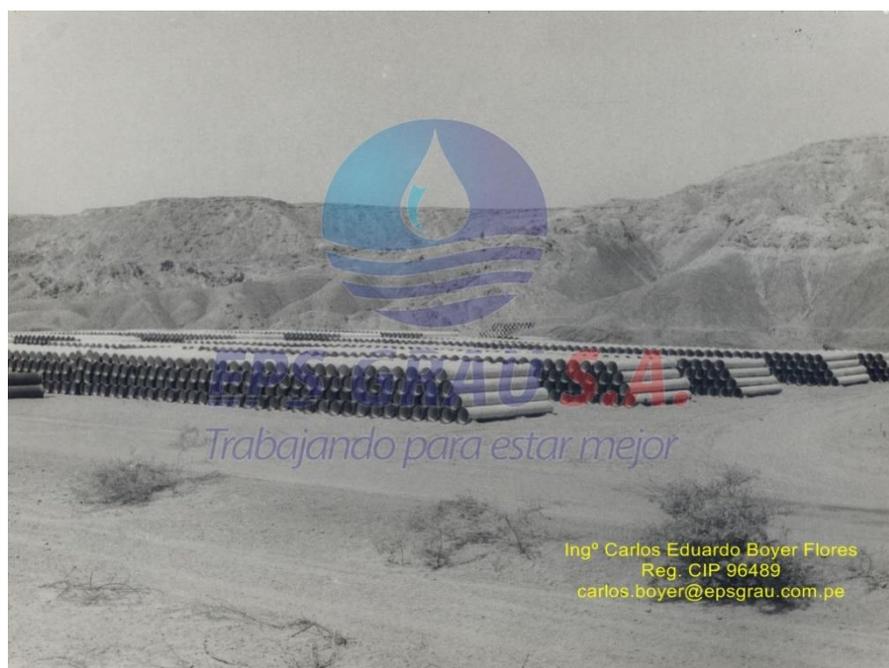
Tuberías de 600 mm a instalar en los Ejes El Arenal-Paita y El Arenal-Talara.
